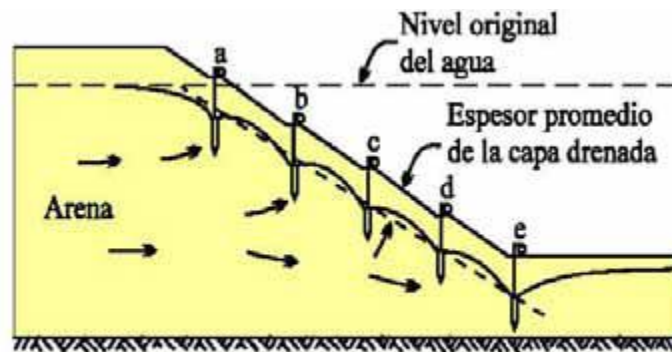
Drenaje de un corte abierto profundo por medio de un sistema de pozos punta
